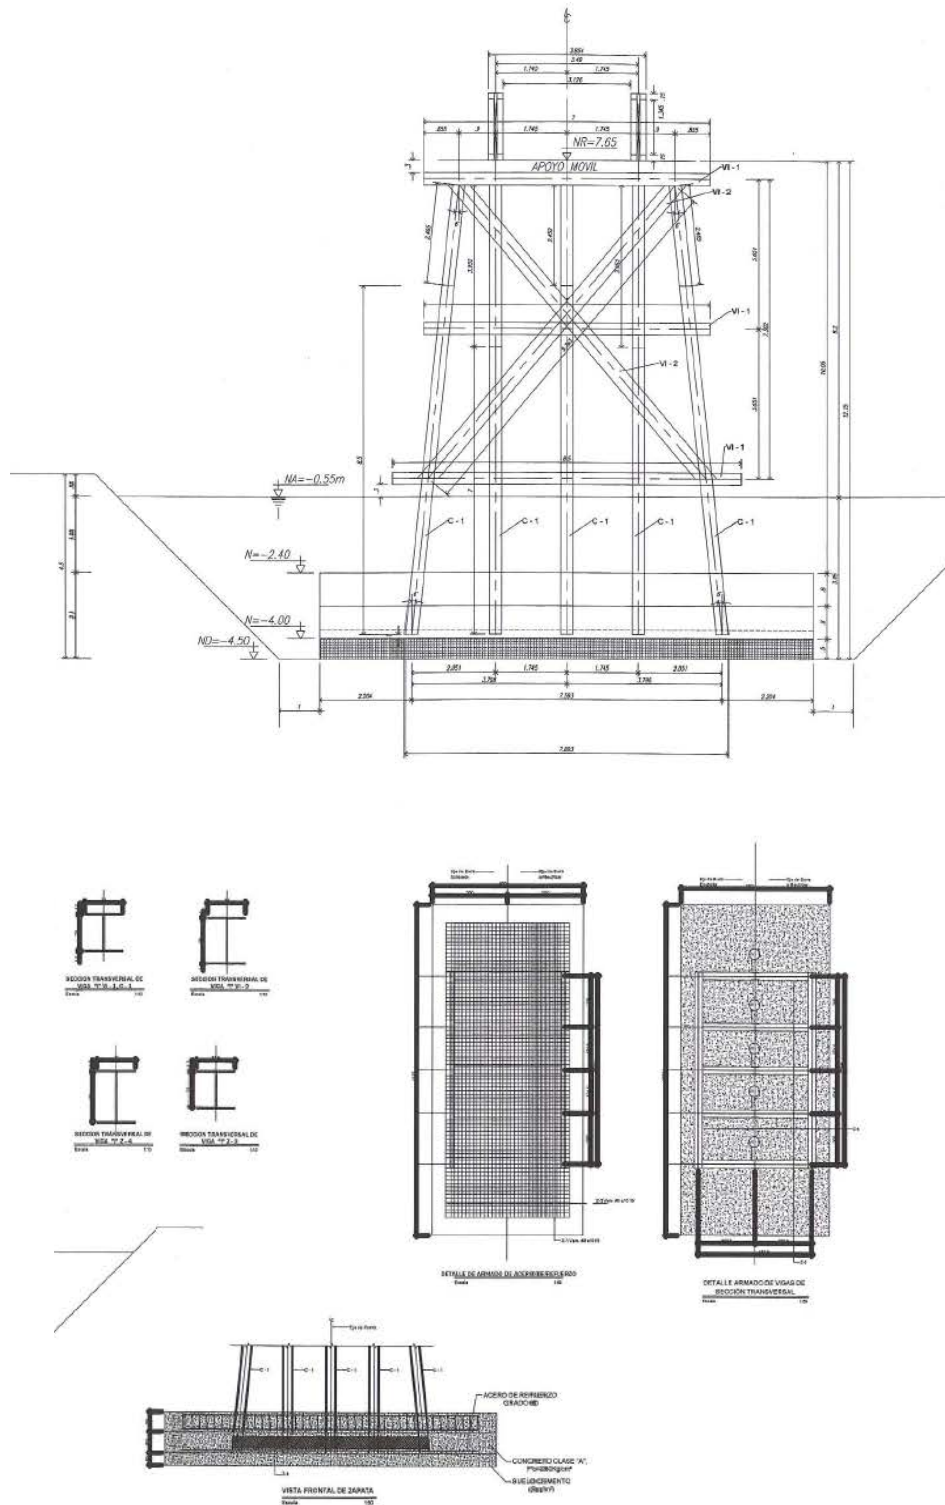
Refuerzo durante Ejecución de Obras (Planificado por la parte japonesa)
